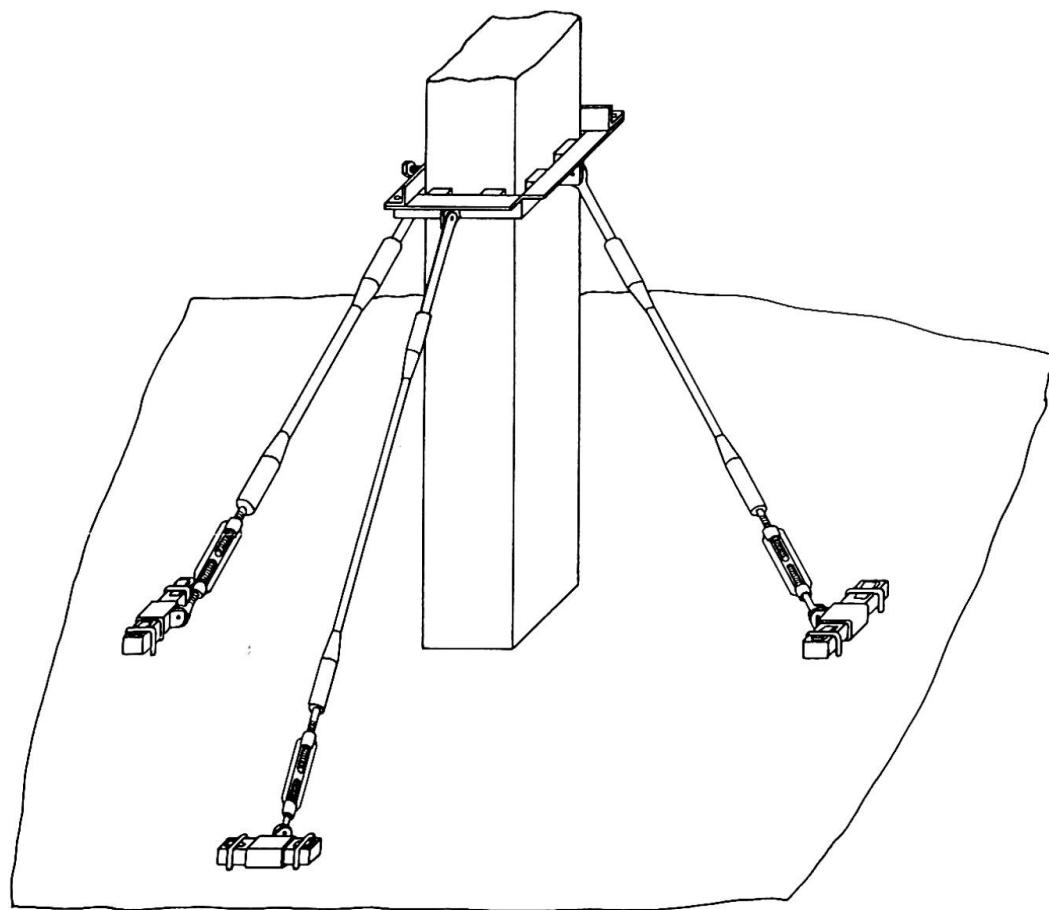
Abstreben mittels zug- und drucksicherer Stahlrohr-Streben, Justieren durch Spannschlösser [5].
